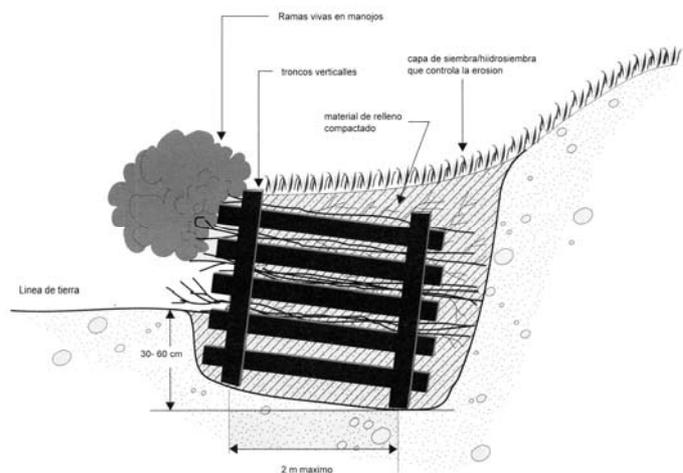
Diseño americano de un entramado de madera. Vista transversal.
